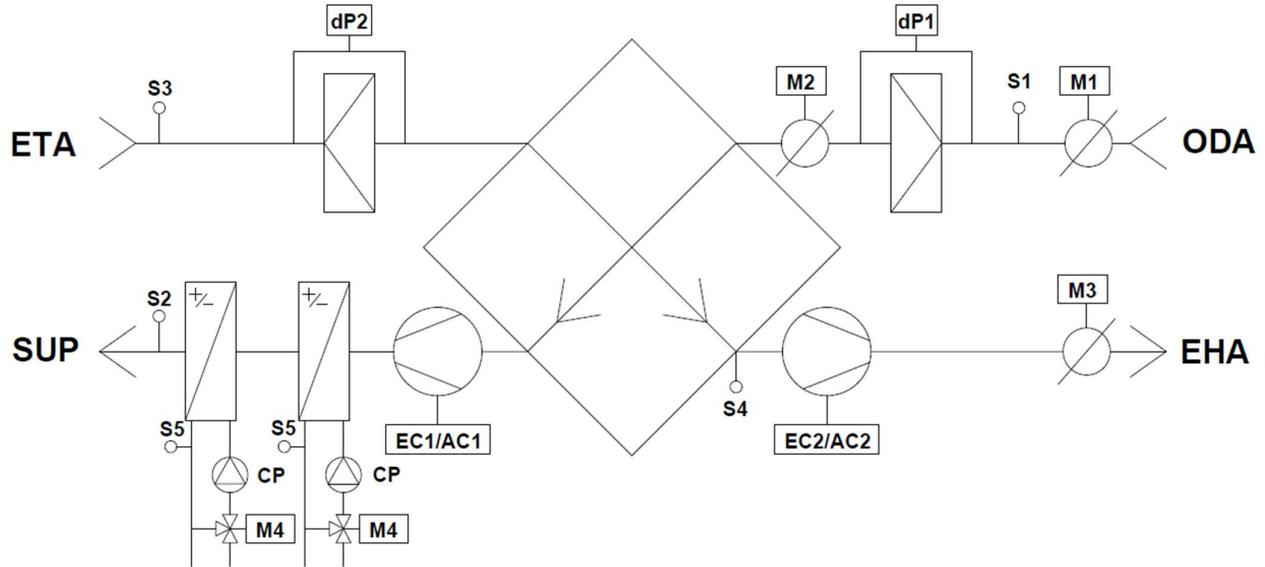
MSR-System, Konfiguration mit Wassererhitzer/Wasserkühler linksseitige Ausführung
